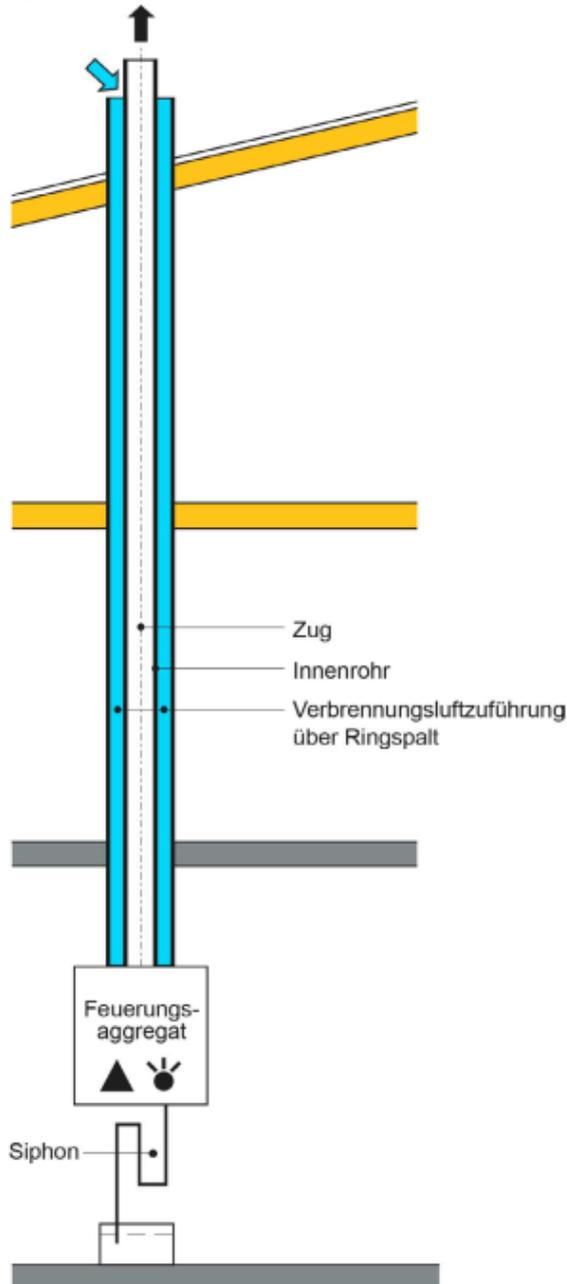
Abgasanlage im Überdruckbetrieb in Brandschutzelement (Schacht) eingebaut
